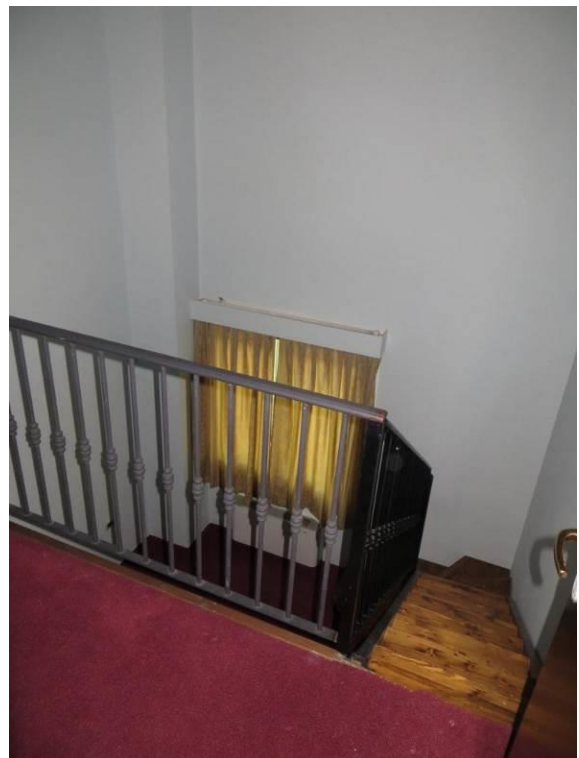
/80 – camera con accesso a ballatoio dal piano primo.
